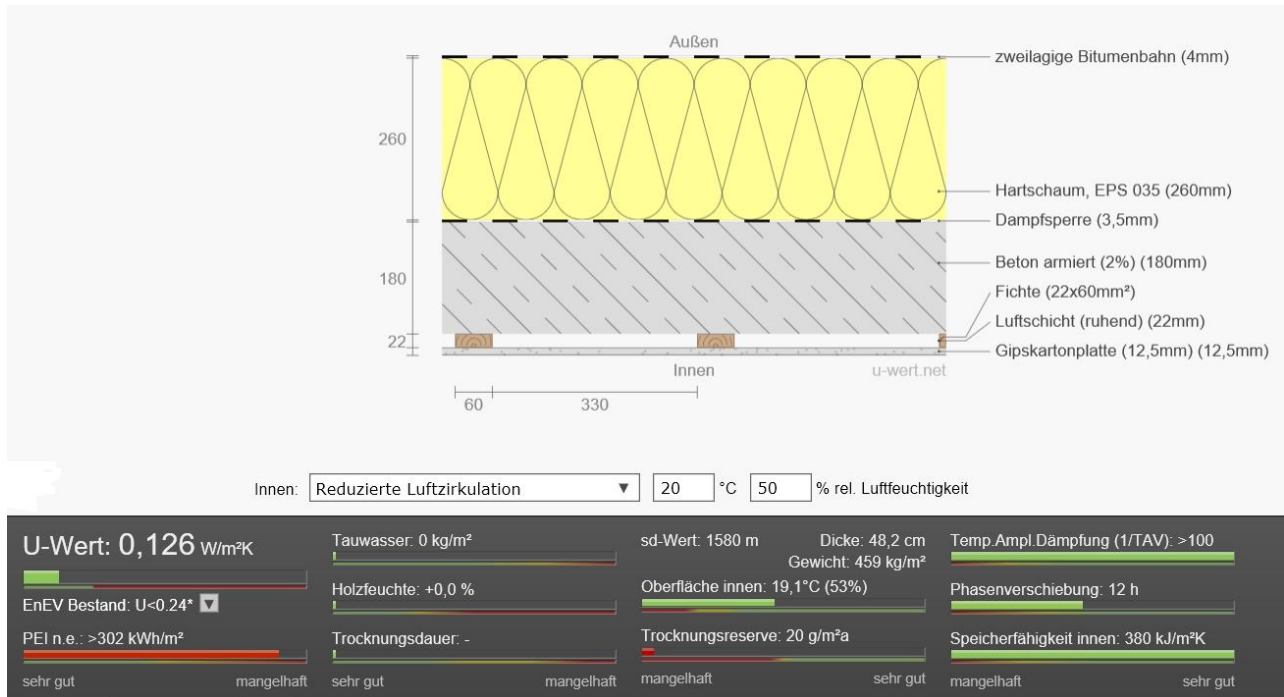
Bauteilaufbau Flachdach, Bauphysik (u-wert.net)
